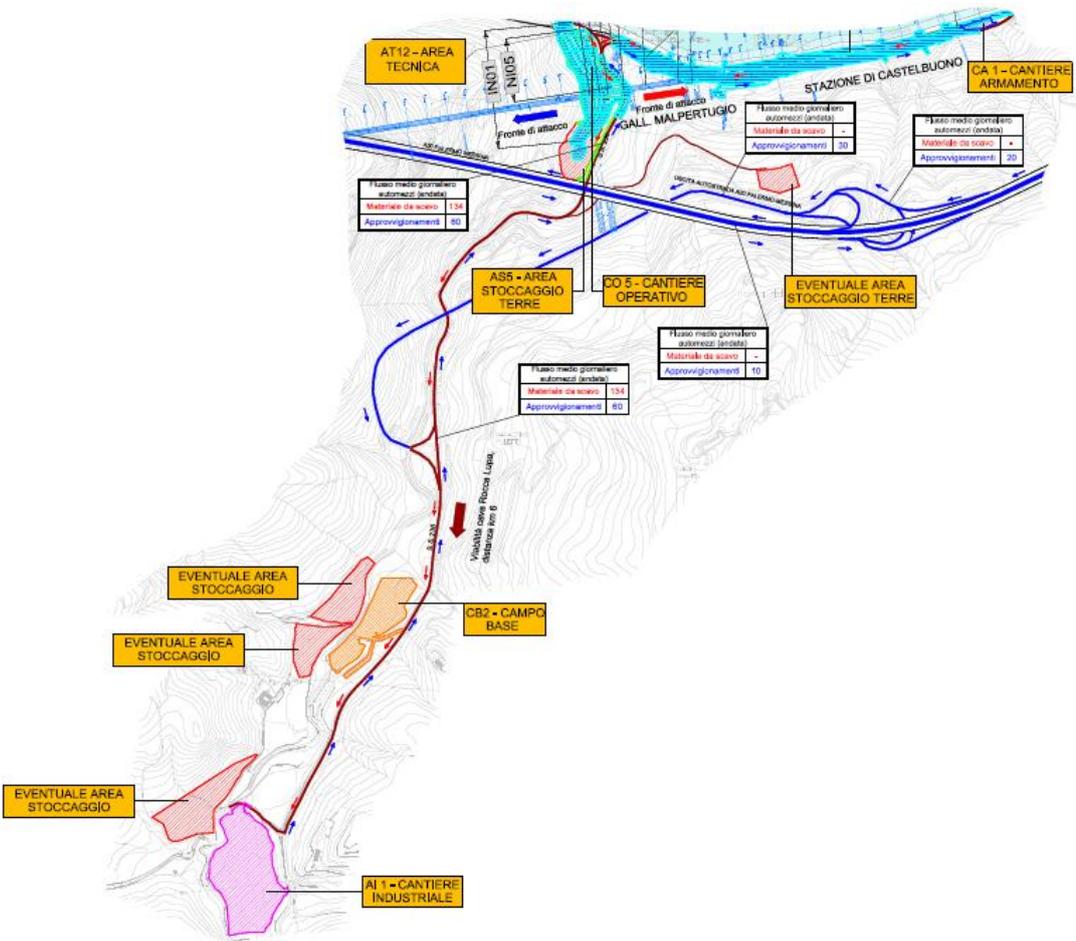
Planimetria d'insieme cantieri area Malpertugio- Castelbuono
